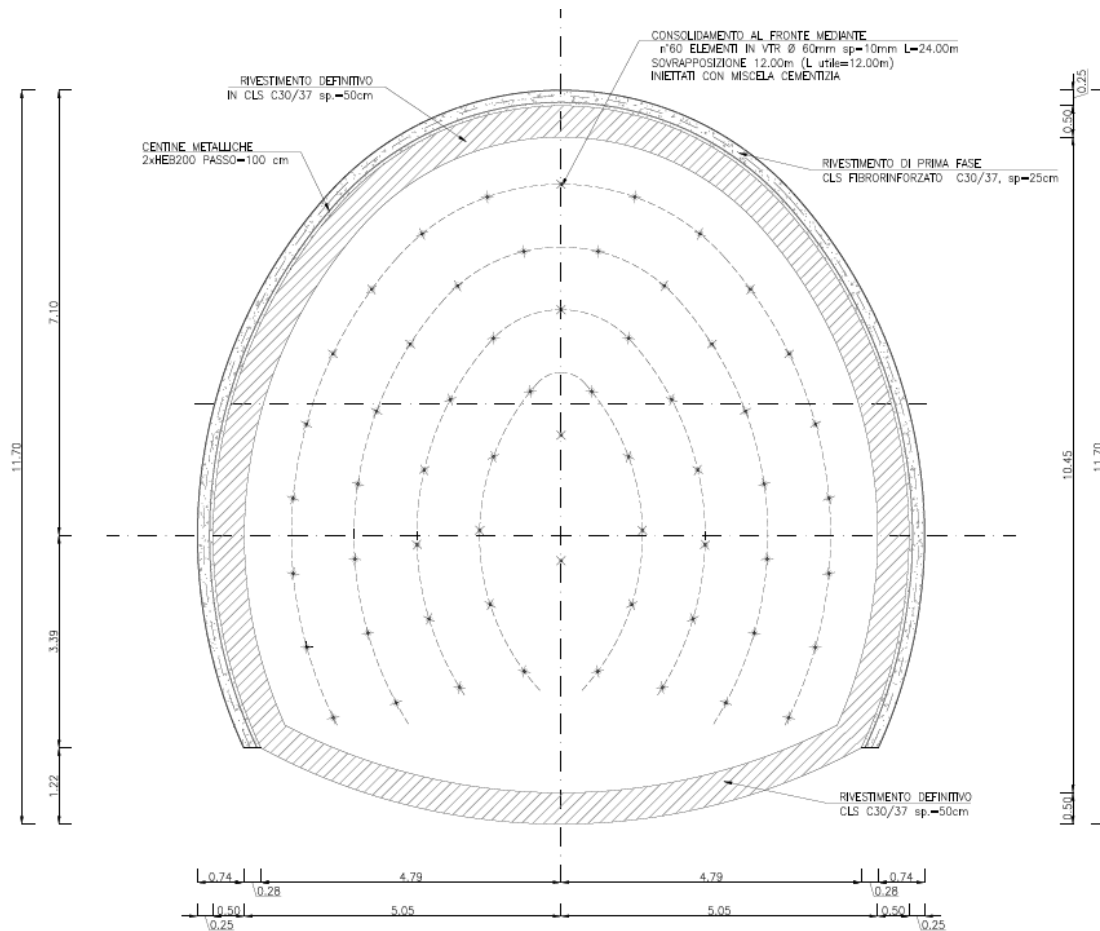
Sezione tipo SGC1: geometria del cavo e interventi di sostegno
